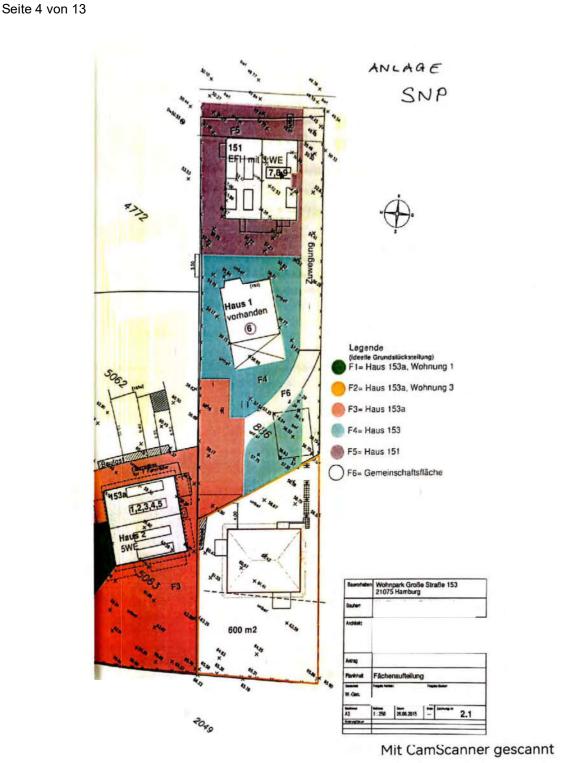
Lageplan mit Kennzeichnung Gemeinschaftsflächen
